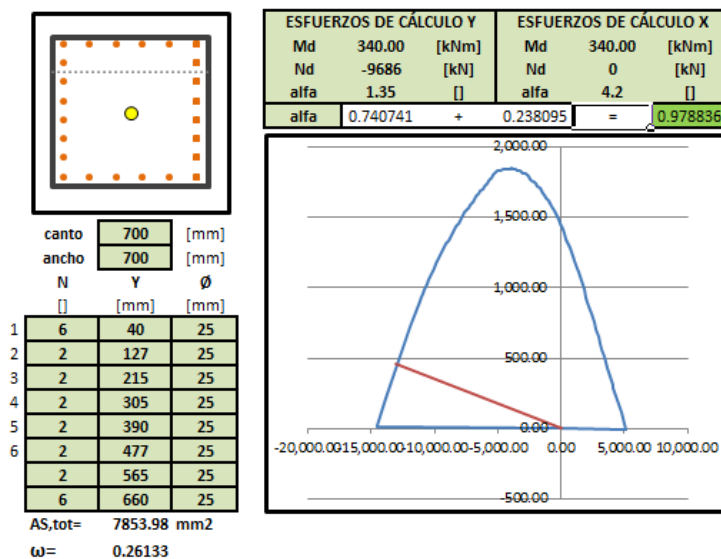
Armado Pilar Sección 70x70 fck 40MPa Tramo sótanos a planta 2º
